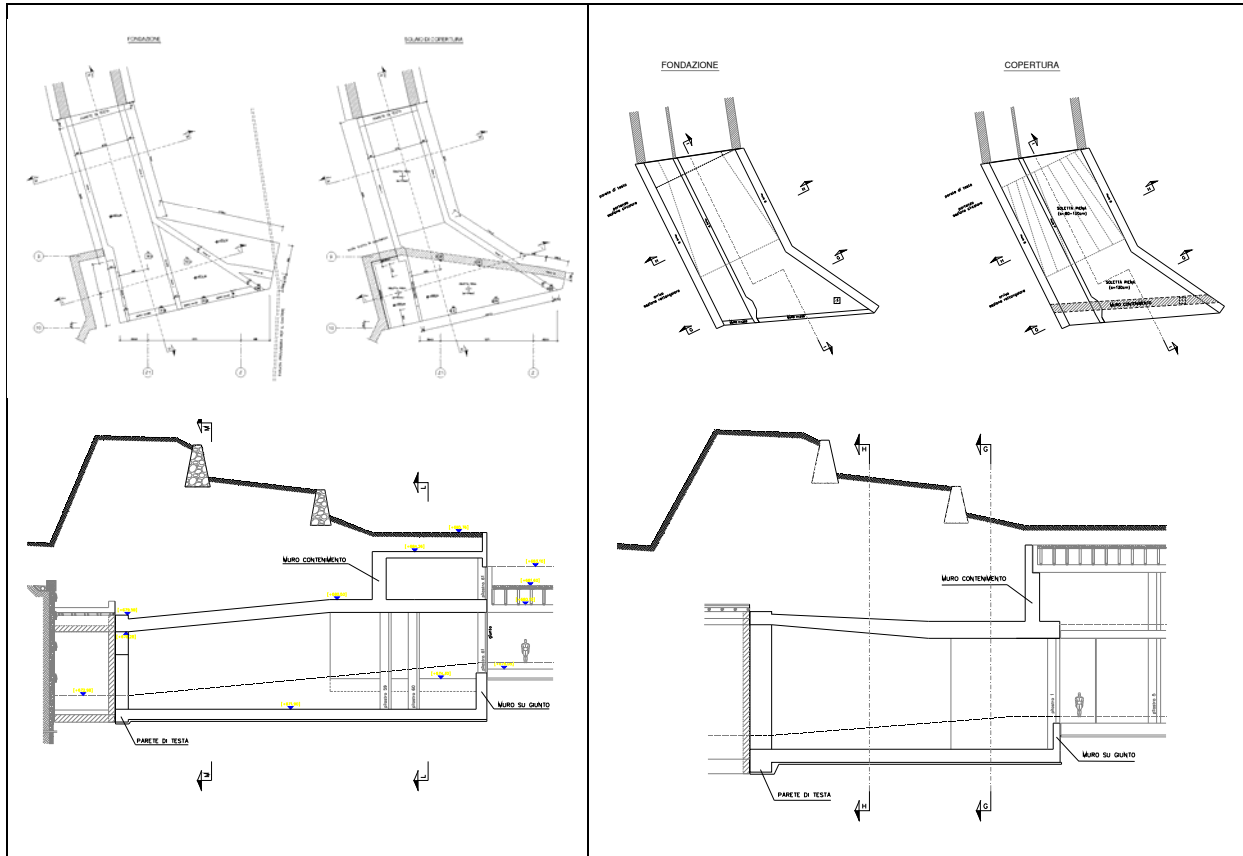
Manufatto di raccordo Maddalena 1 e 2 – piante e sezioni
